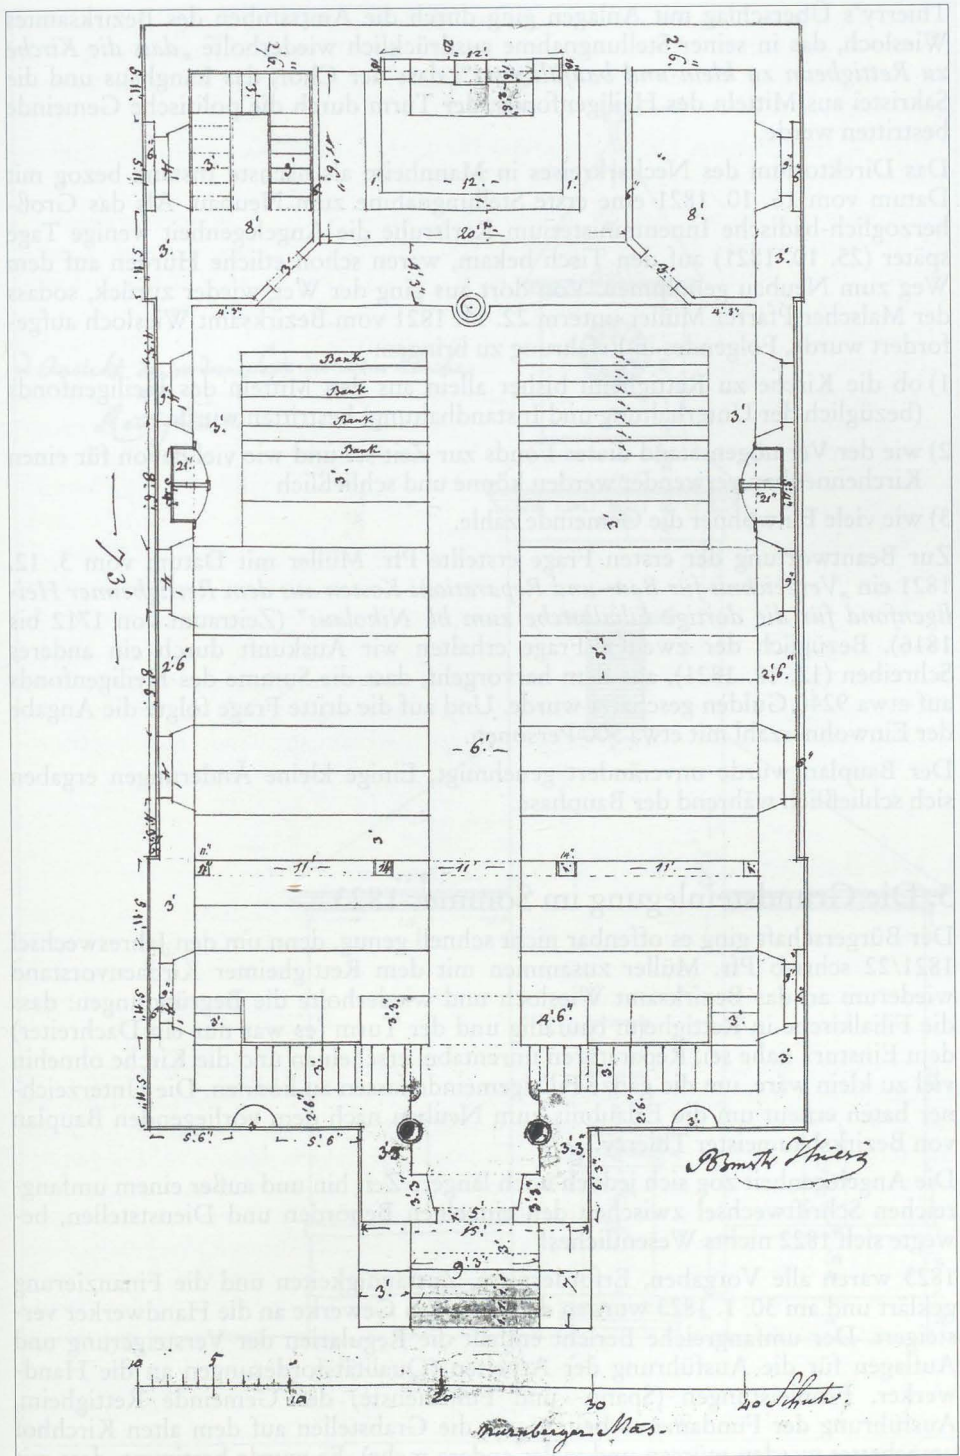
Grundriss Baumeister Thierry nach Nürnberger Maß
